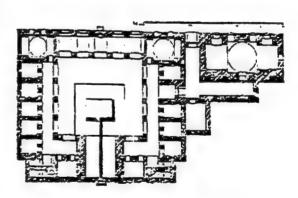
مسقط أفقي لمسجد أحمد المهمندار بالقاهرة (عن محمد حزة)
